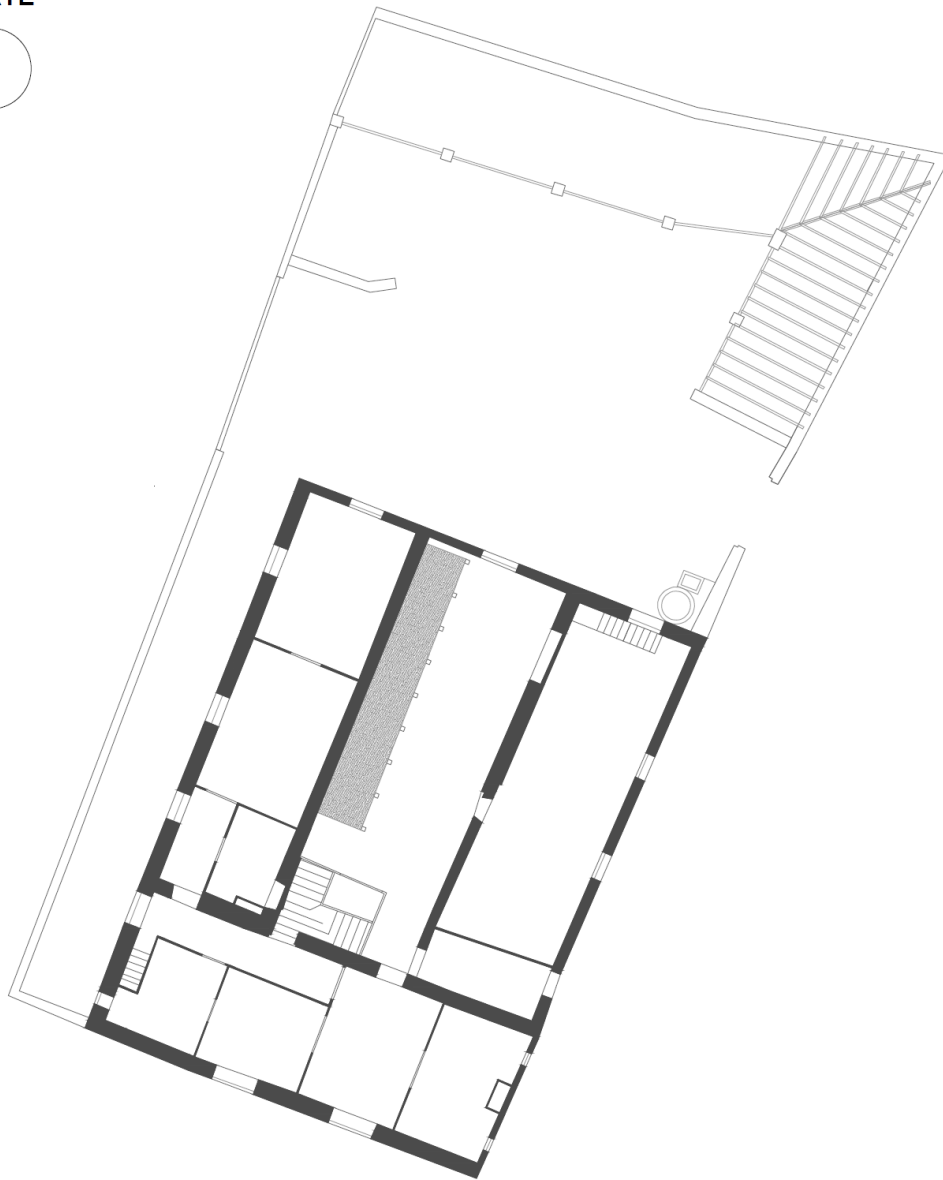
Planta Primera del volumen principal de La Alquería del Moro. Escala 1:250. Fuente propia.
